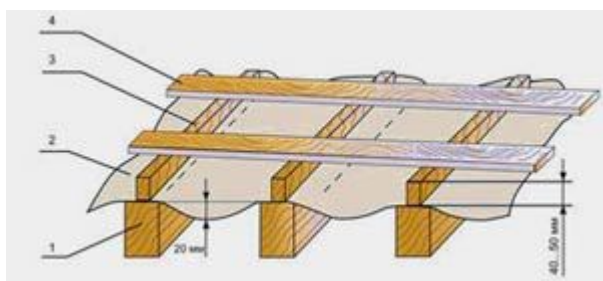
Укладка гидроизоляционной плёнки и обрешётки: 1 - стропильная нога; 2 - гидроизоляция; 3 - стропильная планка (брус конробрешетки); 4 - обрешётка
